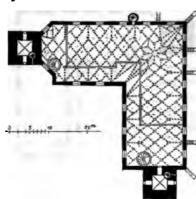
Kirche zu Freudenstadt. Oberer Grundriss.
